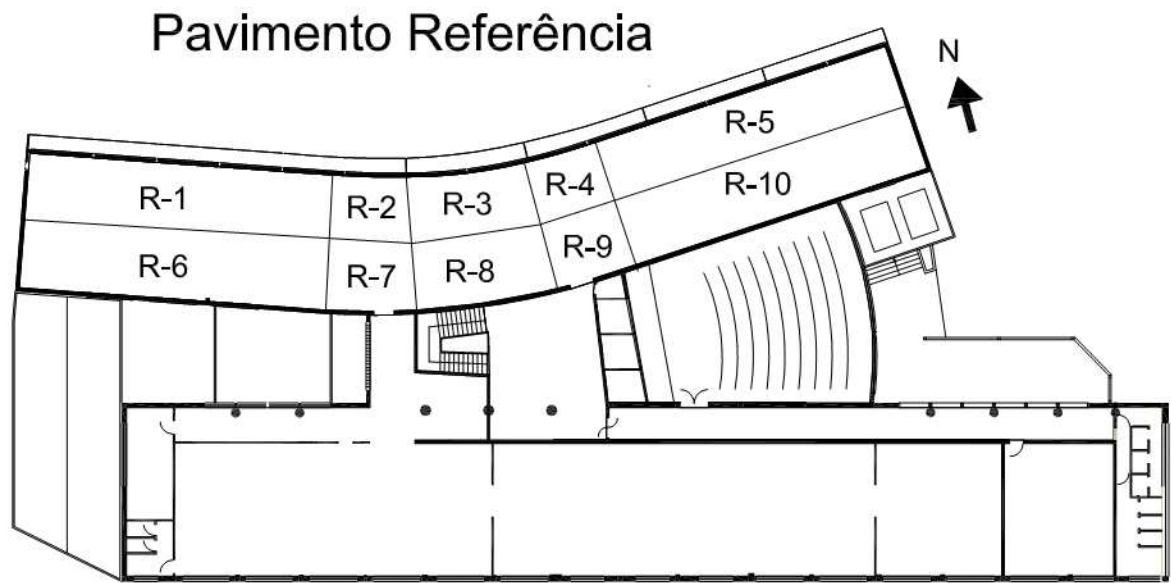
Planta baixa do pavimento referência, zoneamento referência para os demais pavimentos.
